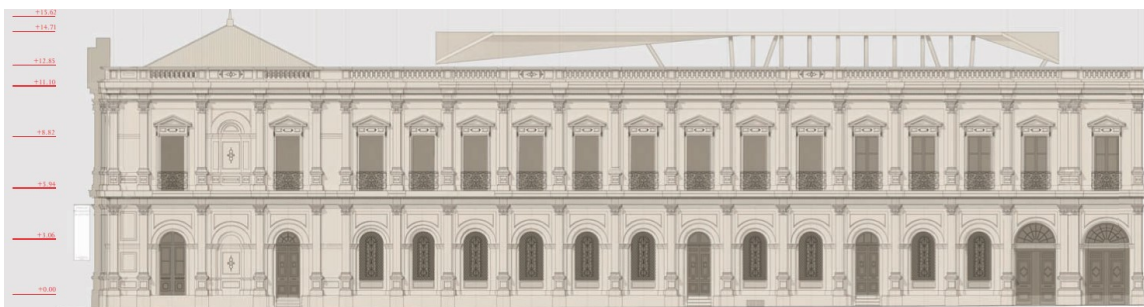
Fachada lateral. Fuente: (Puga, 2012)
